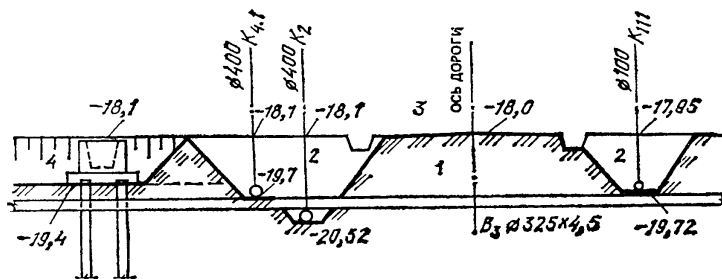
Очередность выполнения работ (1 – 4) по прокладке трубопроводов, забивке свай, устройству ростверков, строительству дорог
